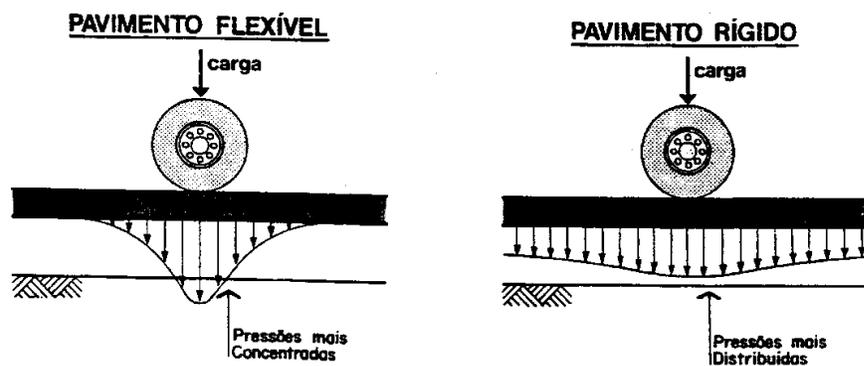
Bacias de deflexão de pavimento flexível e de concreto de cimento Portland
